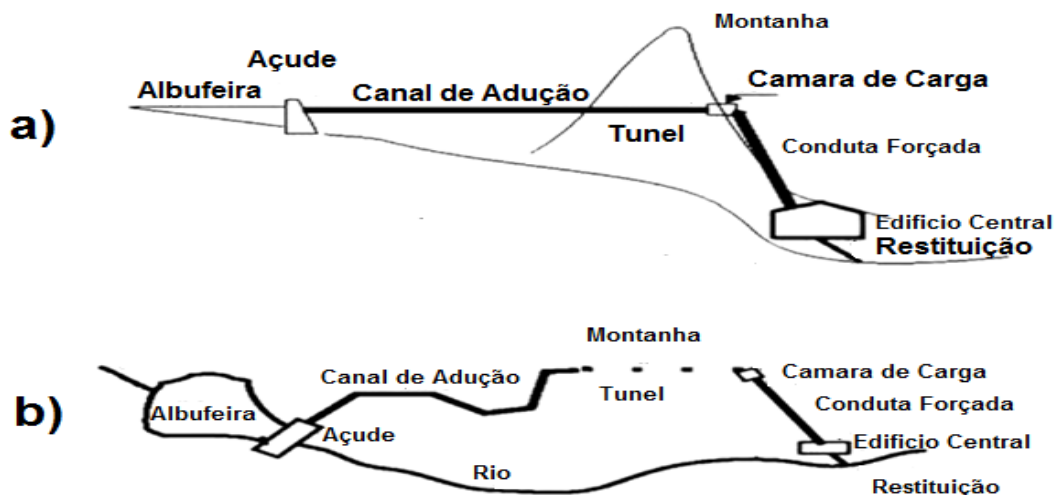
Representação de uma mini-hídrica tipo, em que o açude e a central de turbinagem estão em locais diferentes, vista a) Longitudinal b) Em Planta [17]
